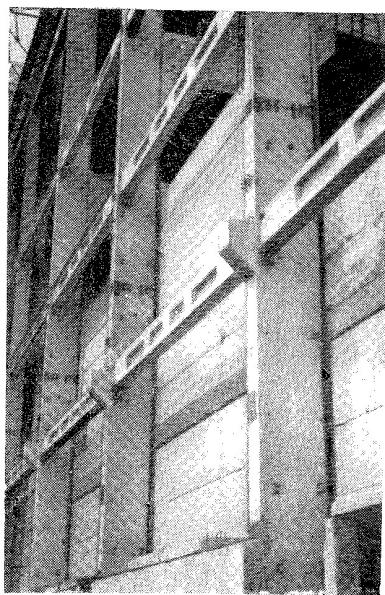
Стыки сборных элементов несущего каркаса главного корпуса
